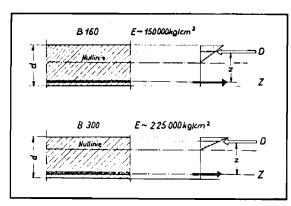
Veränderung des inneren Hebelarms z infolge Änderung der Be-tongülo unter sanst gleichen Verhältnissen (Schema)
